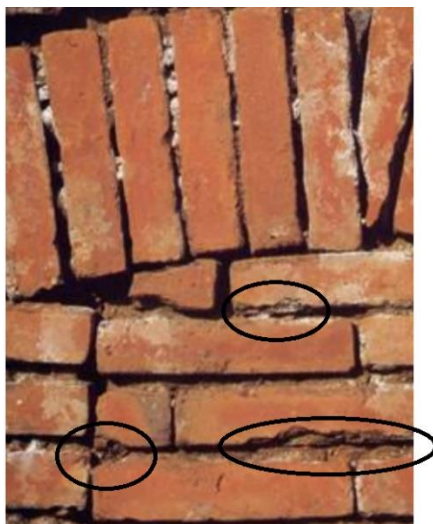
Exemplo de esmagamento dos bordos de tijolos com face à vista
